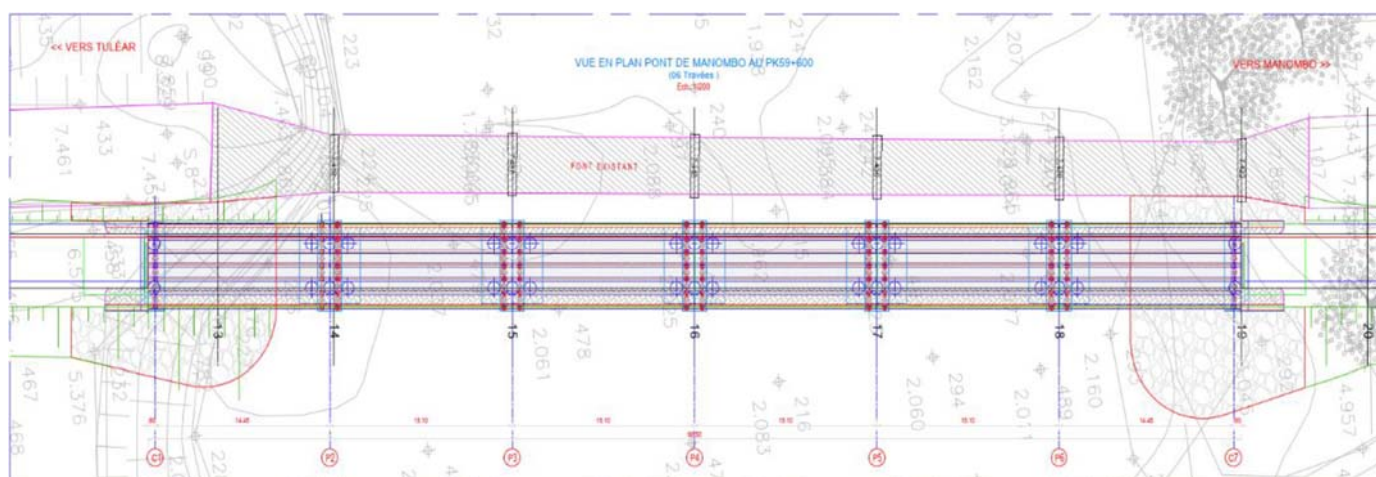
Tracé en plan de la variante 2 du pont de Manombo
